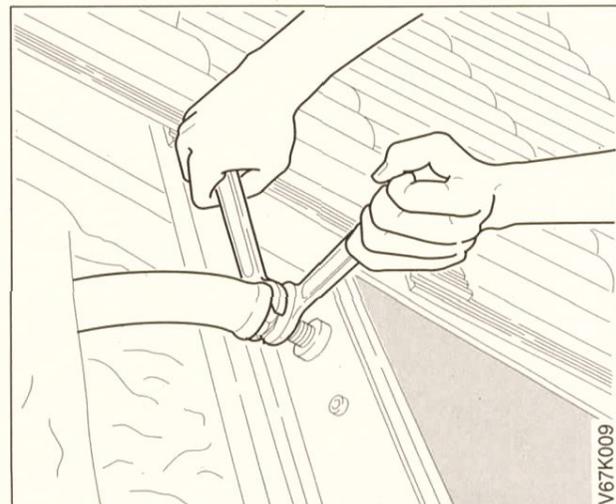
Wellschläuche an freie Kollektoranschlüsse und unter dem Dach an Cu-Rohre des Solarkreises (mit 1/2"-18 mm Nippel) anschließen. Verbindungen abdrücken, falls später Dachunterseite geschlossen ist.
